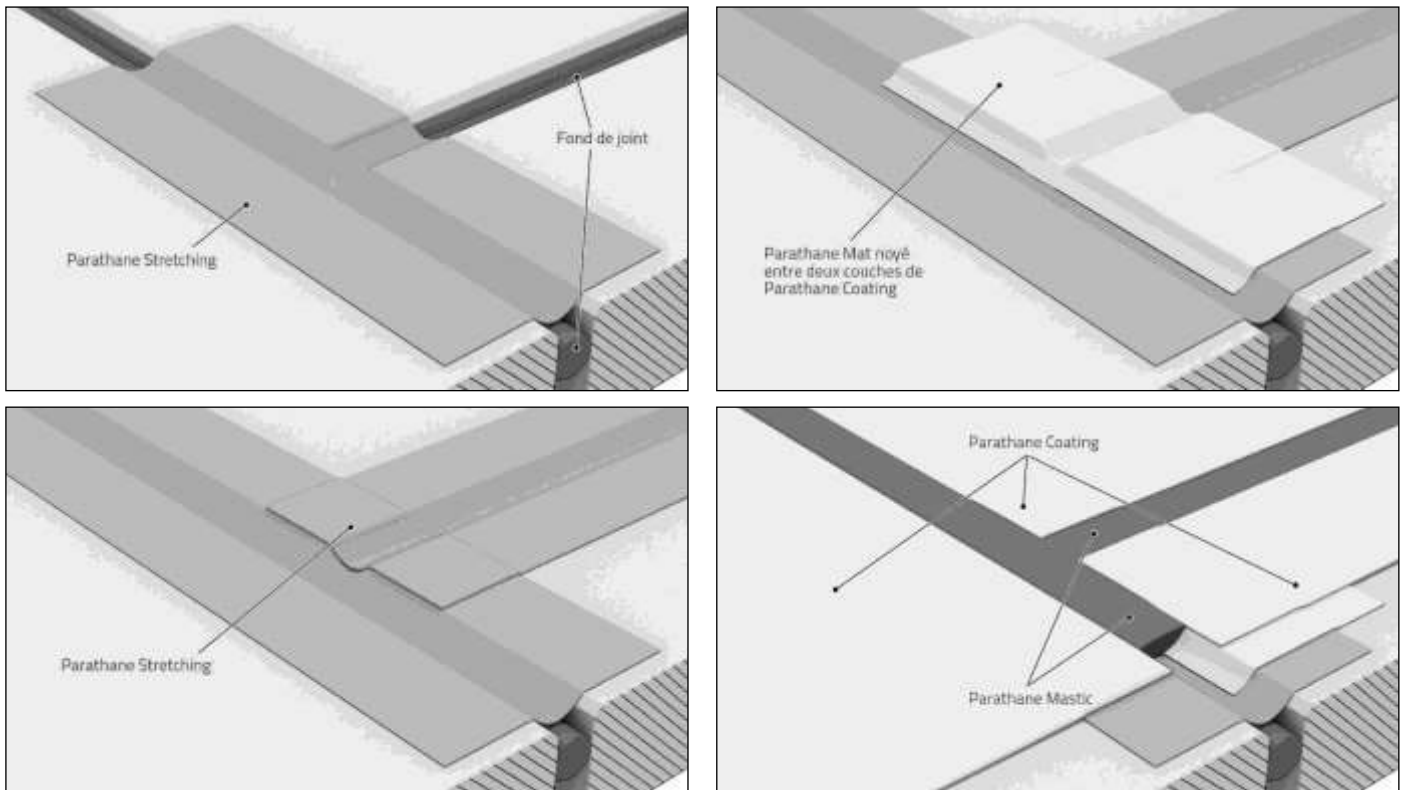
bis - Joint de dilatation sur costière pour terrasse inaccessible, technique, accessible avec dalles sur plots
